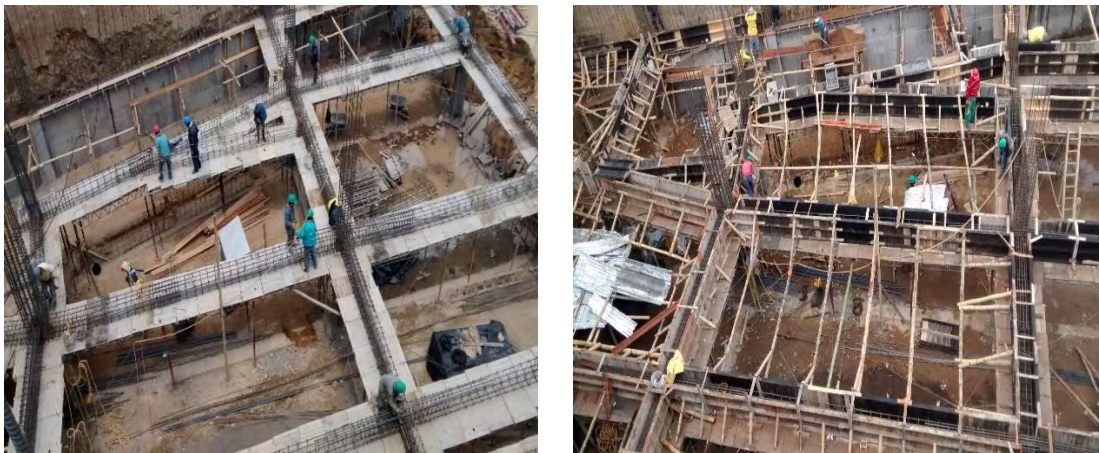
y 57. Armado de refuerzo de muro de contención, armado y apuntalamiento de formaleta.
